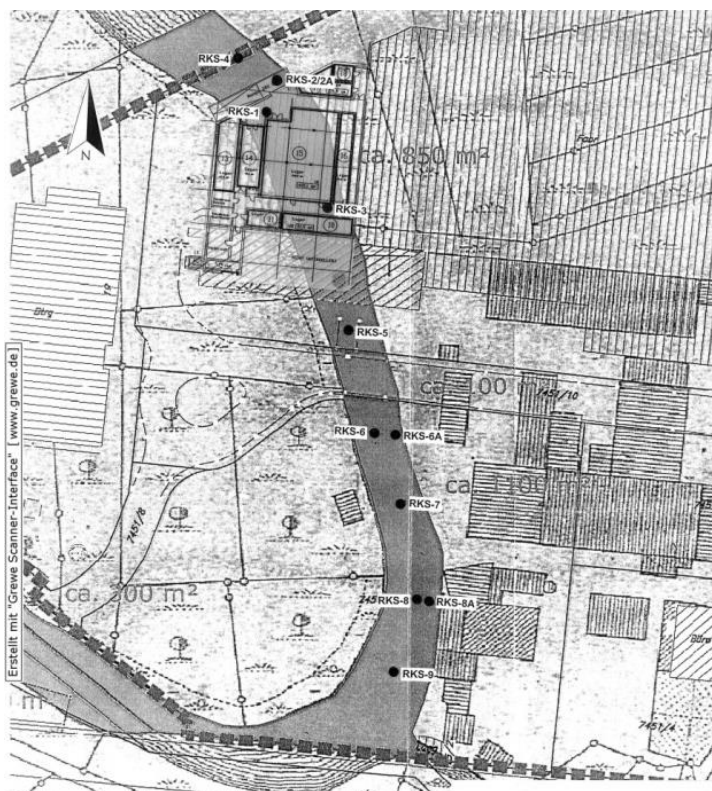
Ausschnitt Lageplan der Probennahmepunkte, Quelle: TerraConcept Consult GmbH
